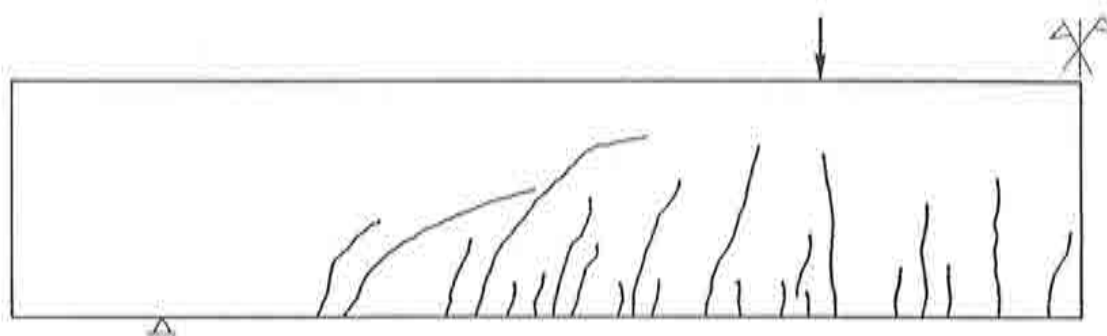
Fisuras experimentales de la viga en el momento del fallo.
